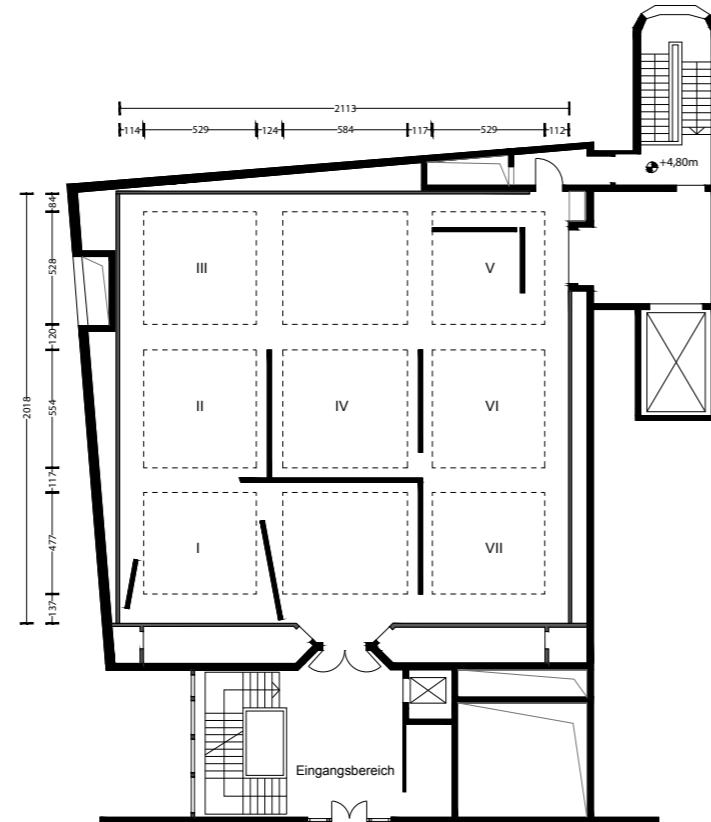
Grundriss des Raumlabors, Entwurf /
